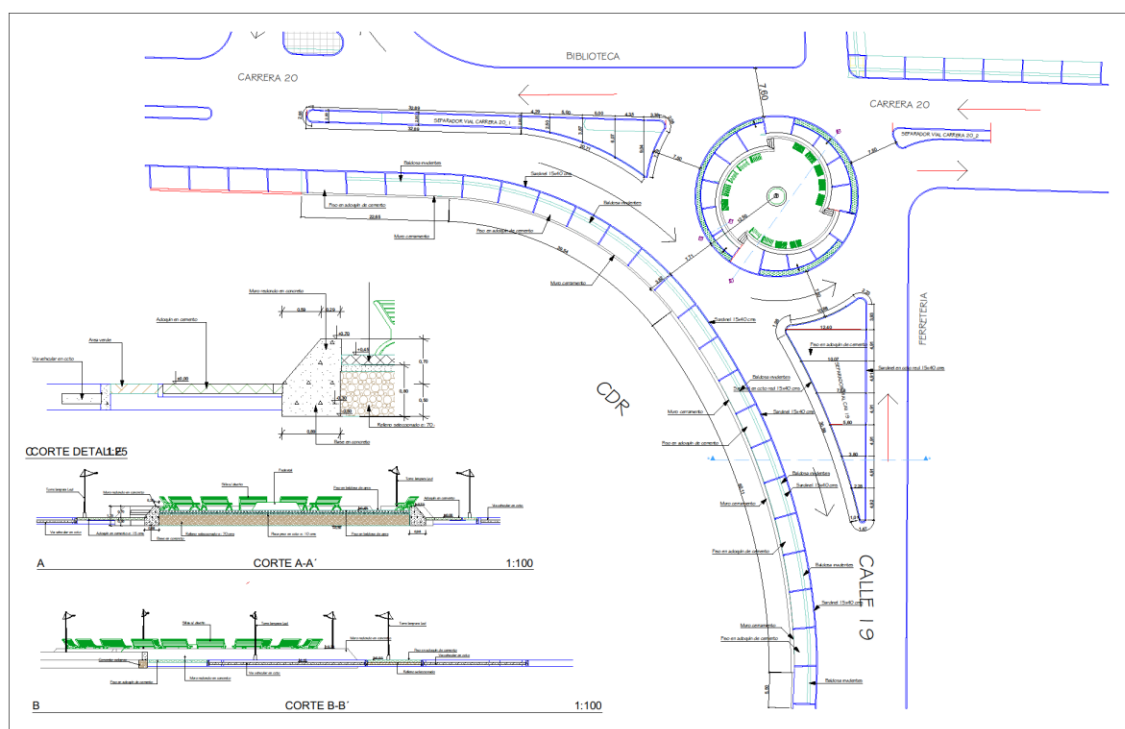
Proyecto glorieta cruce calle 19 con carrera 20.
